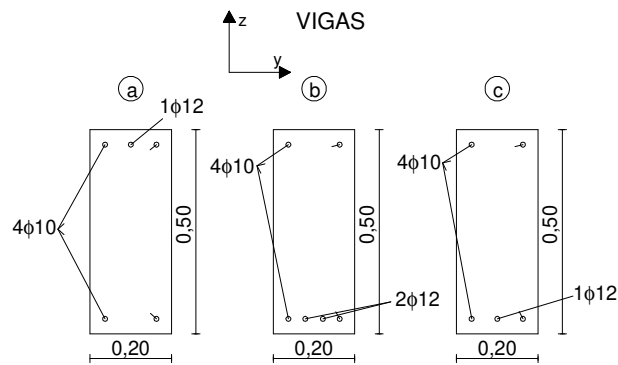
Secções das vigas do pórtico de 3 pisos
